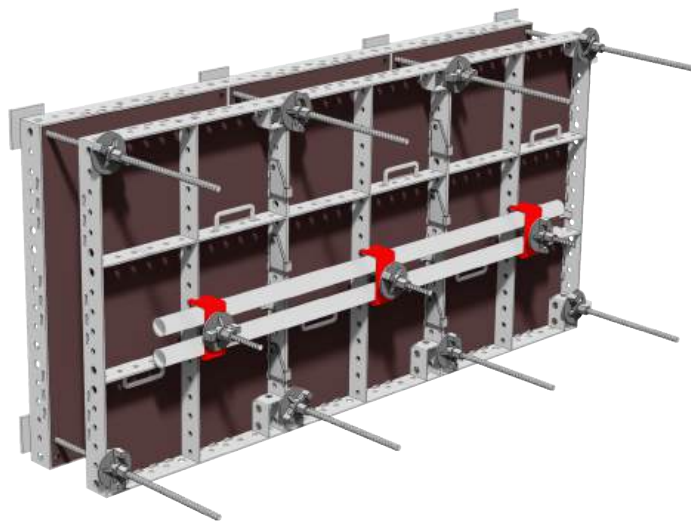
Alinhamento de painéis por garra tubular Tekko® SH
